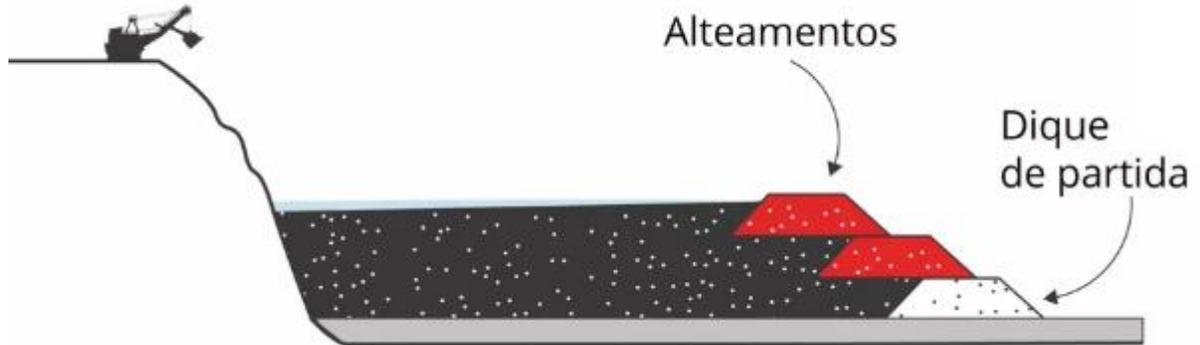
esquema da construção da barragem do tipo a montante (ALVARENGA e CAVALINI, 2019).
